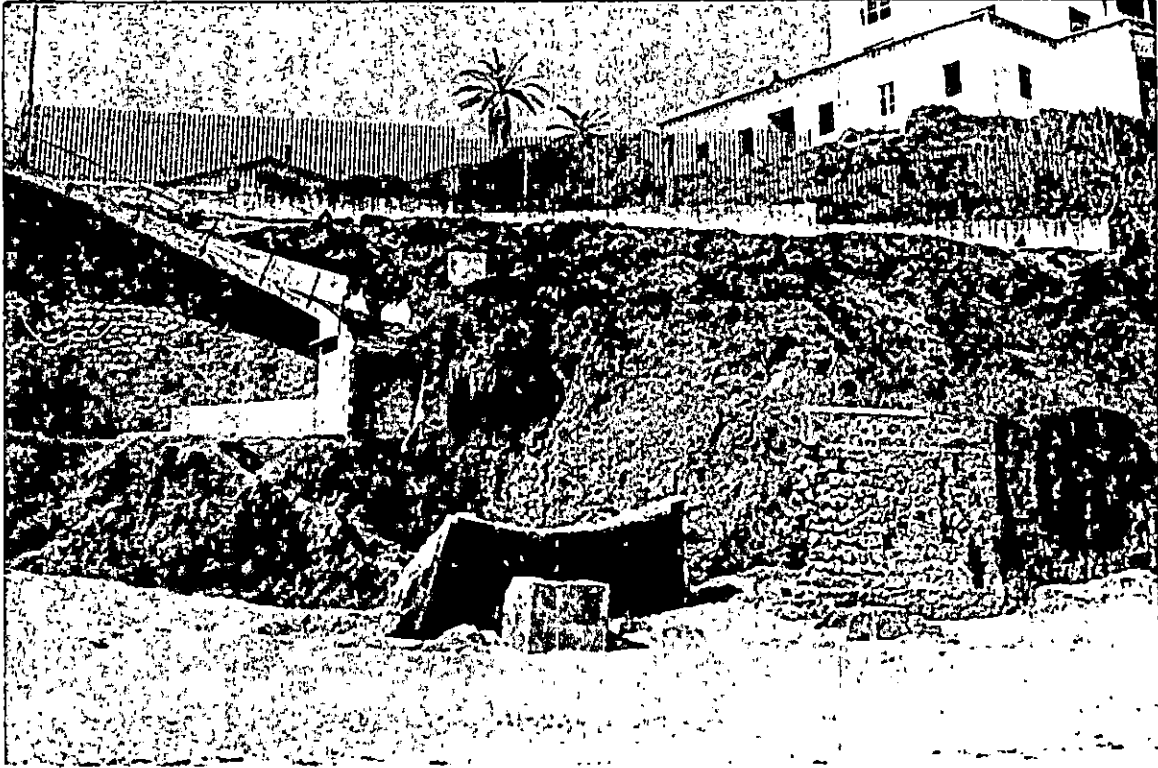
Affouillement des murs de protection et destruction de l'escalier près de l'hotel Tamaris - Ain Taya centre
